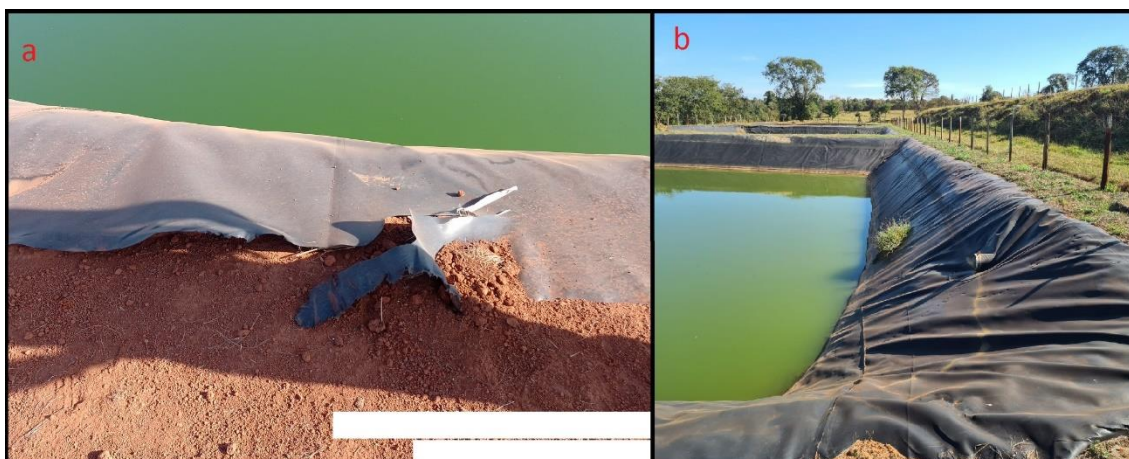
Anomalias na manta de impermeabilização. a) Falha na ancoragem, b) Rasgo na manta com crescimento de vegetação. Fonte: Acervo feam.
